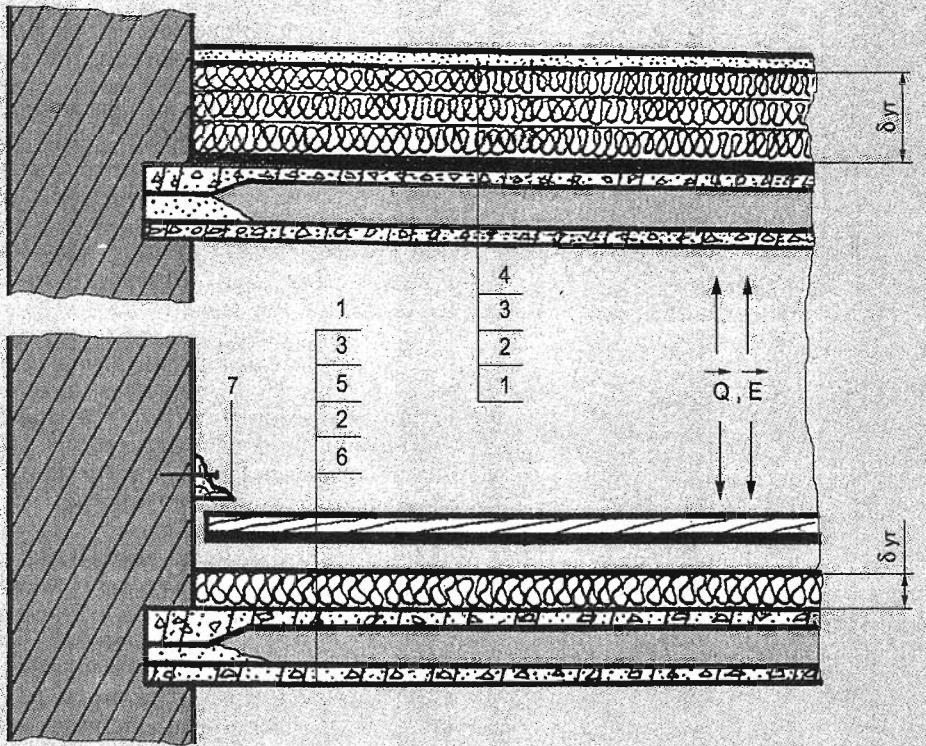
Утепление конструкций перекрытий здания: а – чердачное перекрытие; б – надподвальное перекрытие; 1 – железобетонная плита перекрытия; 2 – пароизоляция; 3 – утеплитель расчетной толщины; 4 – паропроницаемая (на основе известковых вяжущих) армированная стяжка (к исполнению желательна, но необязательна); 5 – воздушный продух; 6 – конструкция чистого пола; 7 – плинтус, устанавливаемый на деревянные подкладки толщиной 1–1,5 см (конструкция образует щель воздухообмена); QE – векторы направления теплового и влажностного потоков
